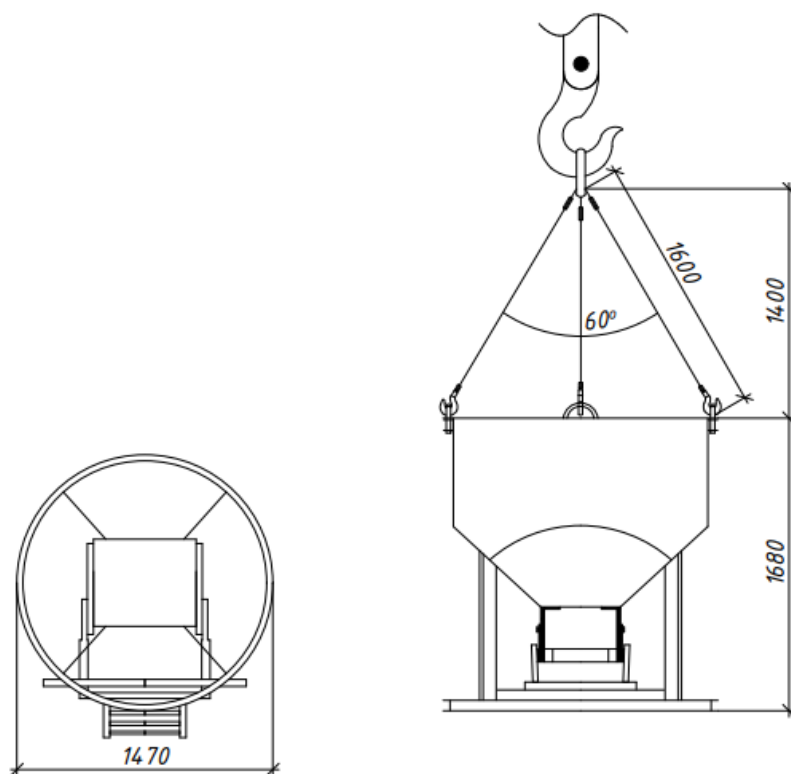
Схема определение высоты строповки для бады с бетоном
